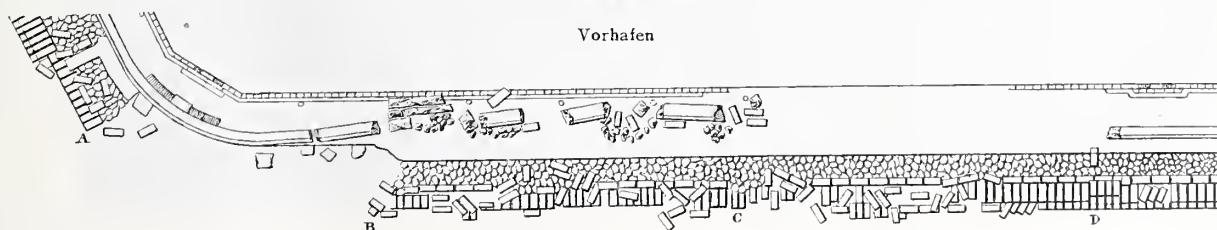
Lageplan des Molo Galliera an der Durchbruchstelle. — Masstab 1:2000.
